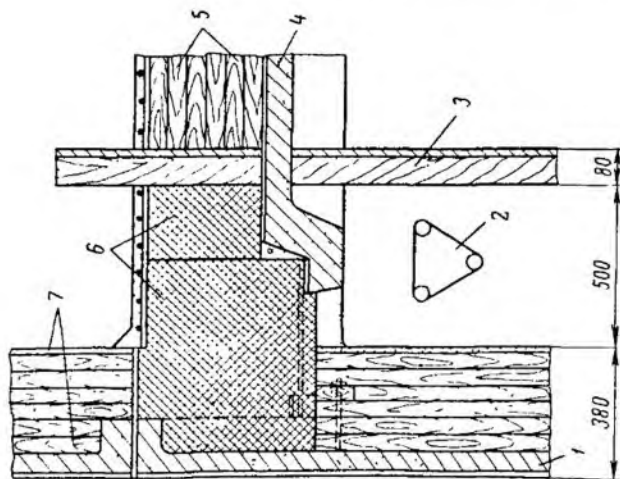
Изоляционные конструкции наружных стен холодильника:
